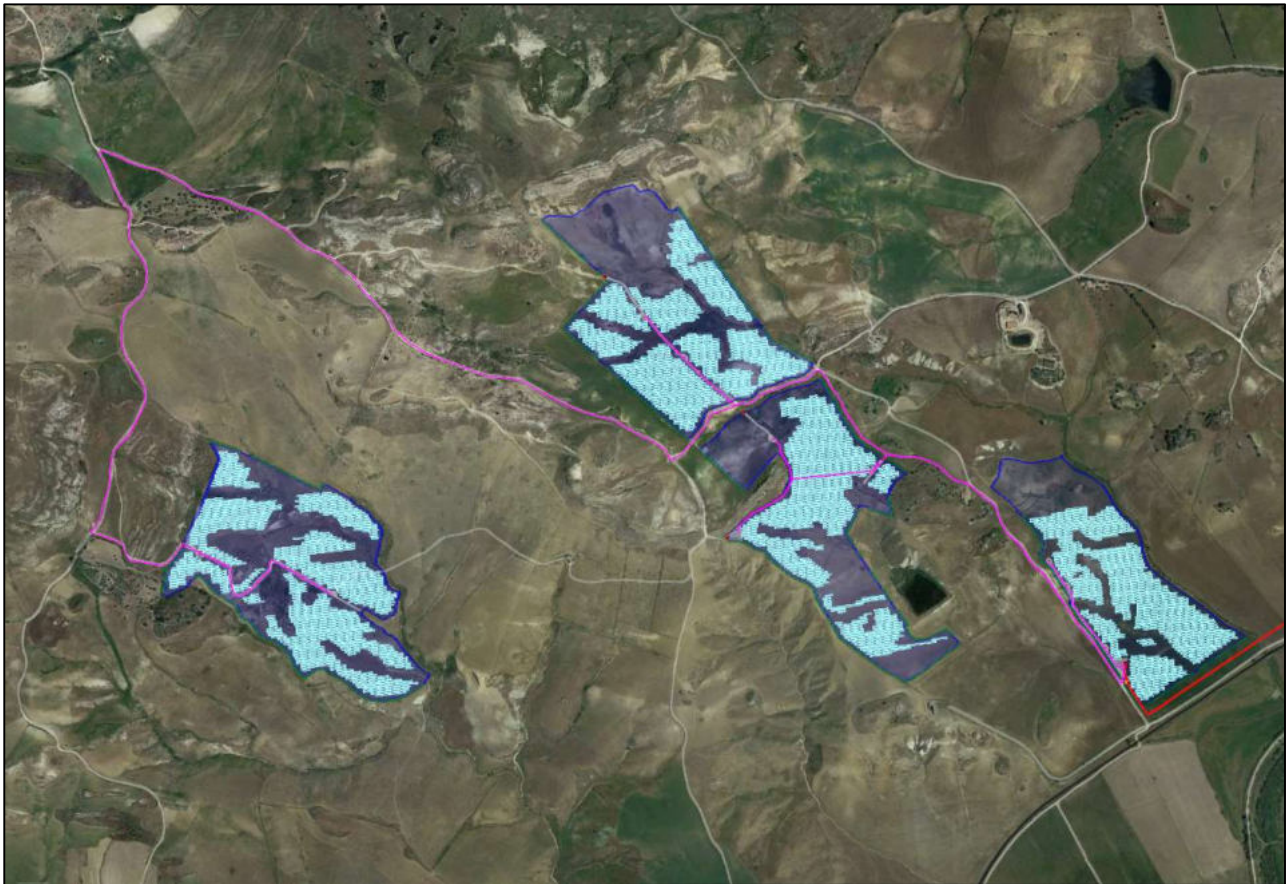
layout* di progetto con la distribuzione dei sottocampi (da stralcio progettuale)
